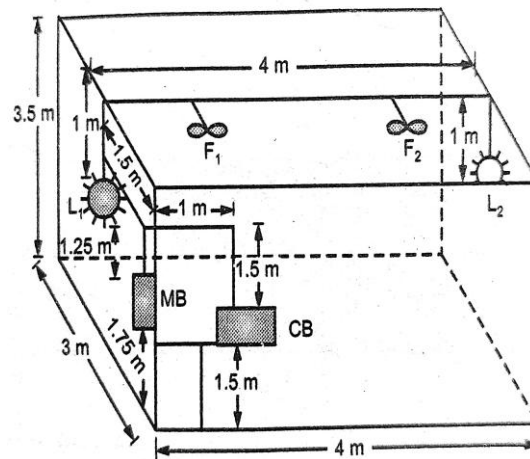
इलेक्ट्रिकल प्लॅन (Electrical Plan)
